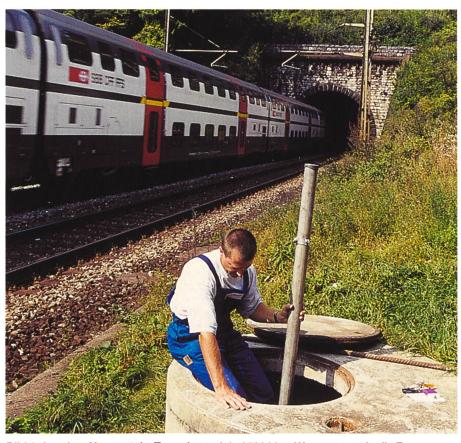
Aus dem Hauenstein-Tunnel sprudeln 2500 Liter Warmwasser in die Fassung – pro Minute.
